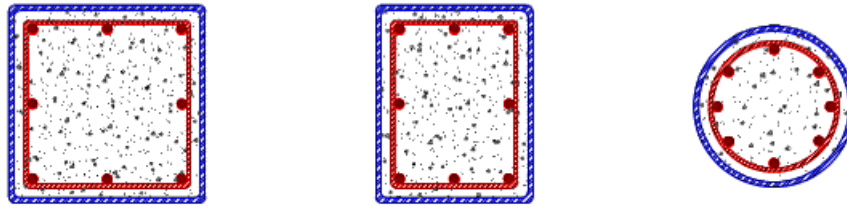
Miembros Compuestos de Perfiles de Acero rellenos de Hormigón Estructural con Hormigón Armado
